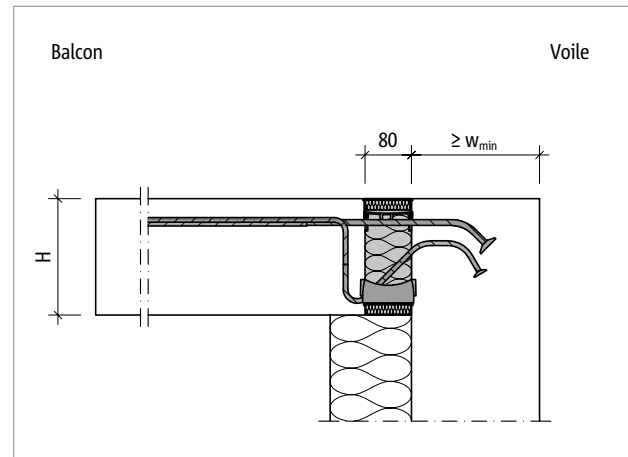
Schöck Isokorb® T Type K-O : Raccordement mural vers le bas avec isolation externe
